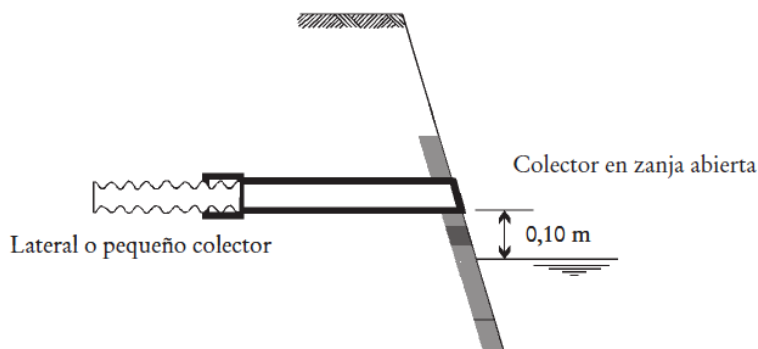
Salida por gravedad con canaletas (Fuente FAO)
